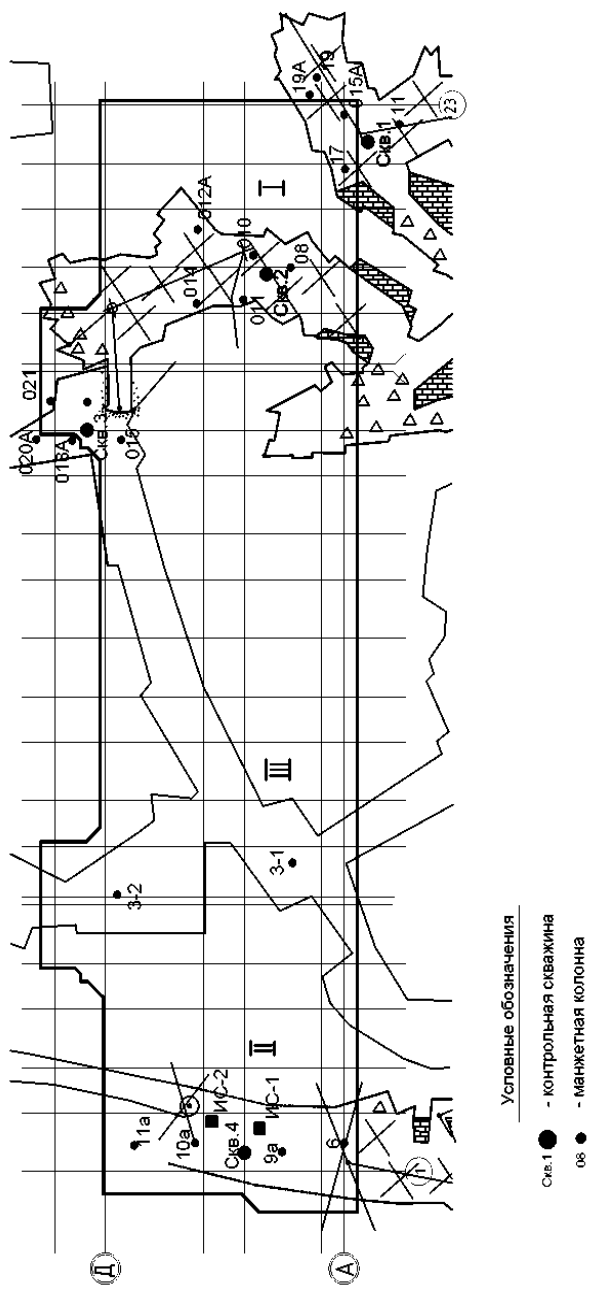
Совмещенный план подземных выработок, манжетных колоны, контрольных скважин и опытных свай на площадке строительства жилого дома №3.
